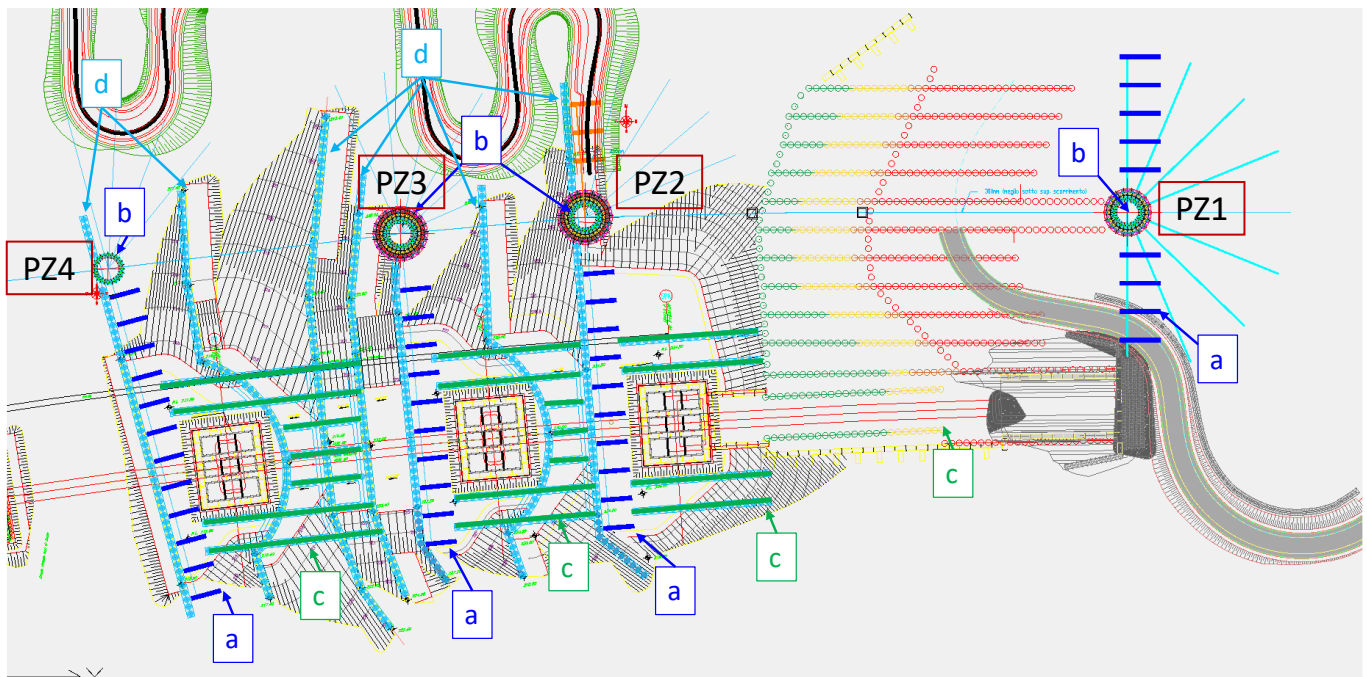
planimetria dell'intervento con l'ubicazione delle principali opere di stabilizzazione.
